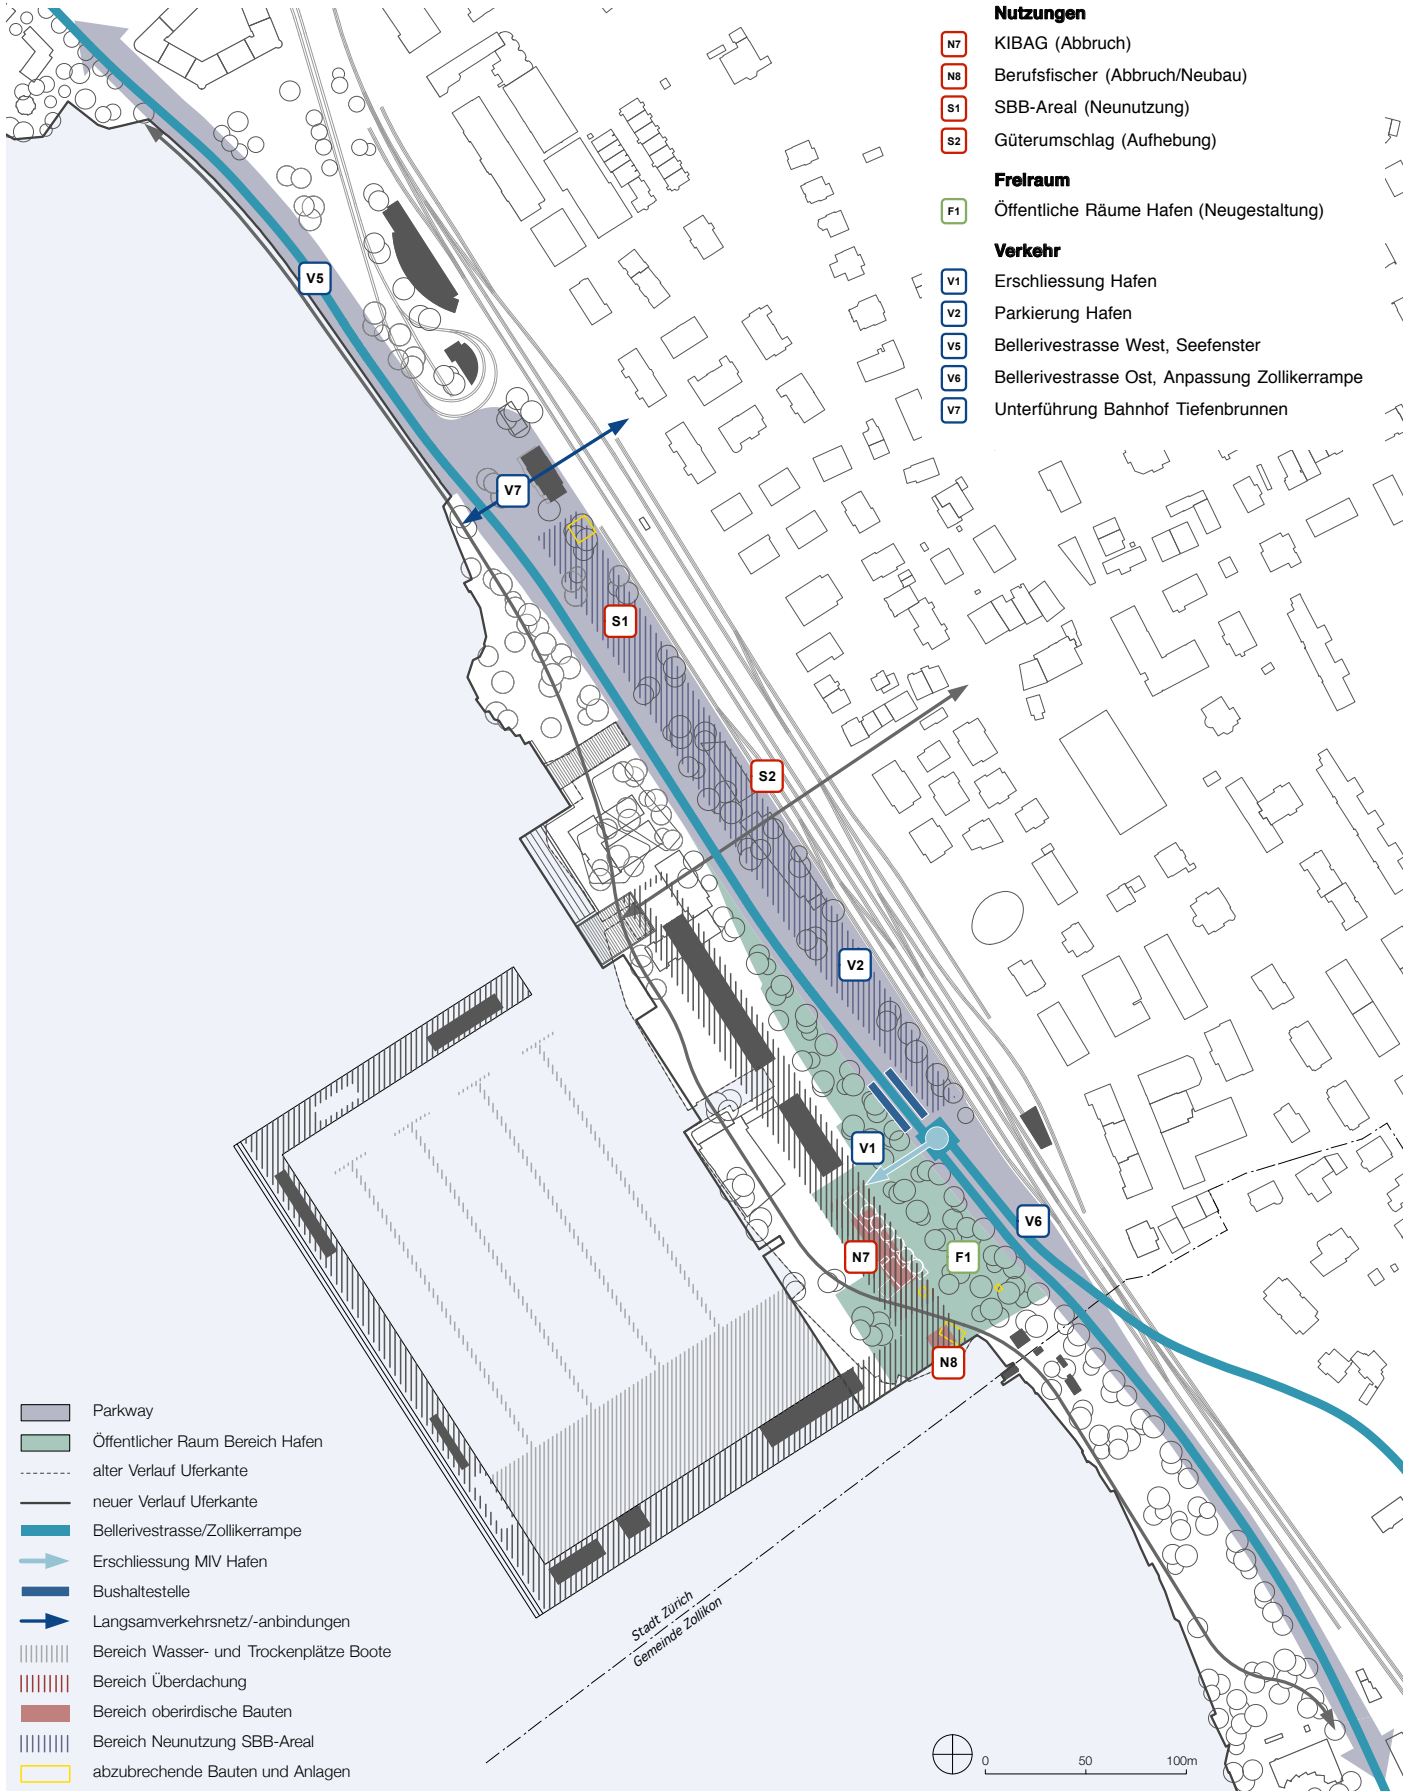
Bestandteile Bellerivestrasse – Zollikerrampe
